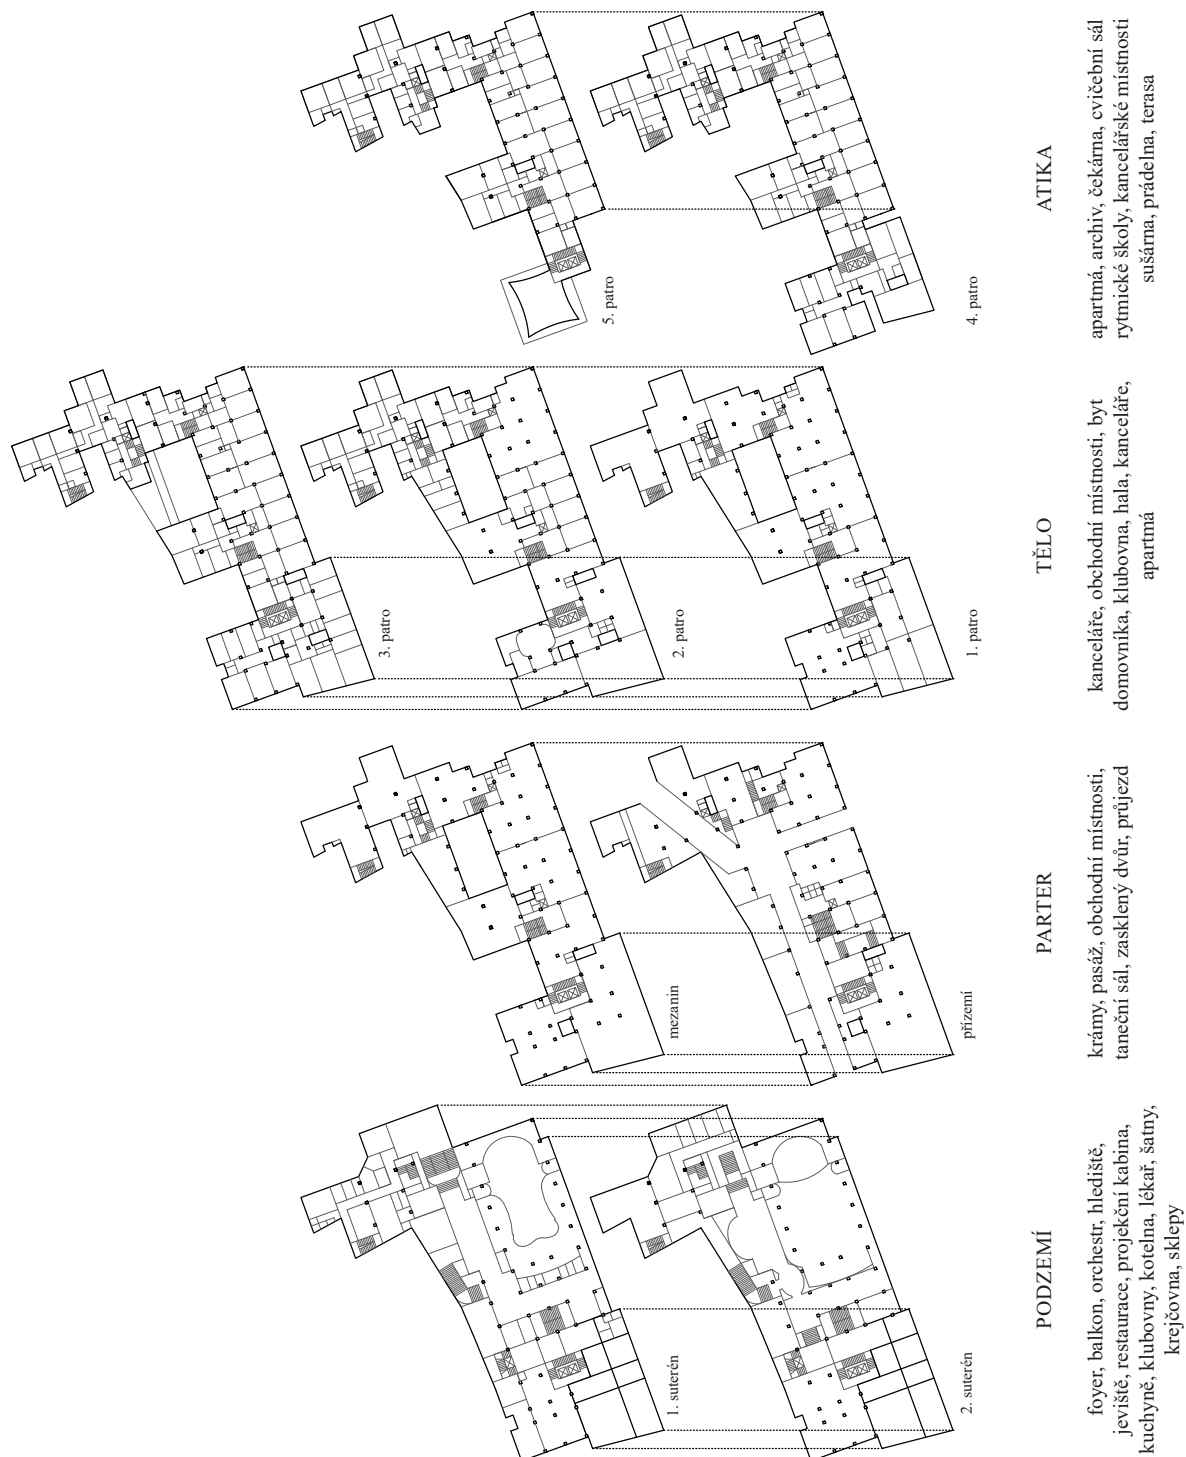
Rozložené plány paláce Avion 1:1500.
